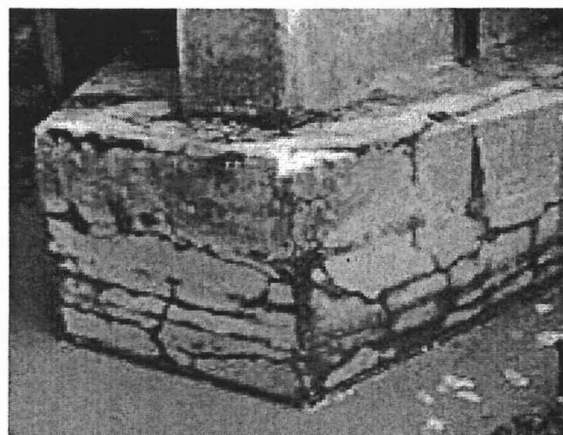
Vista lateral do pilar mostrando o padrão de fissuração subparalelo do concreto na porção inferior do bloco junto a água que mina
